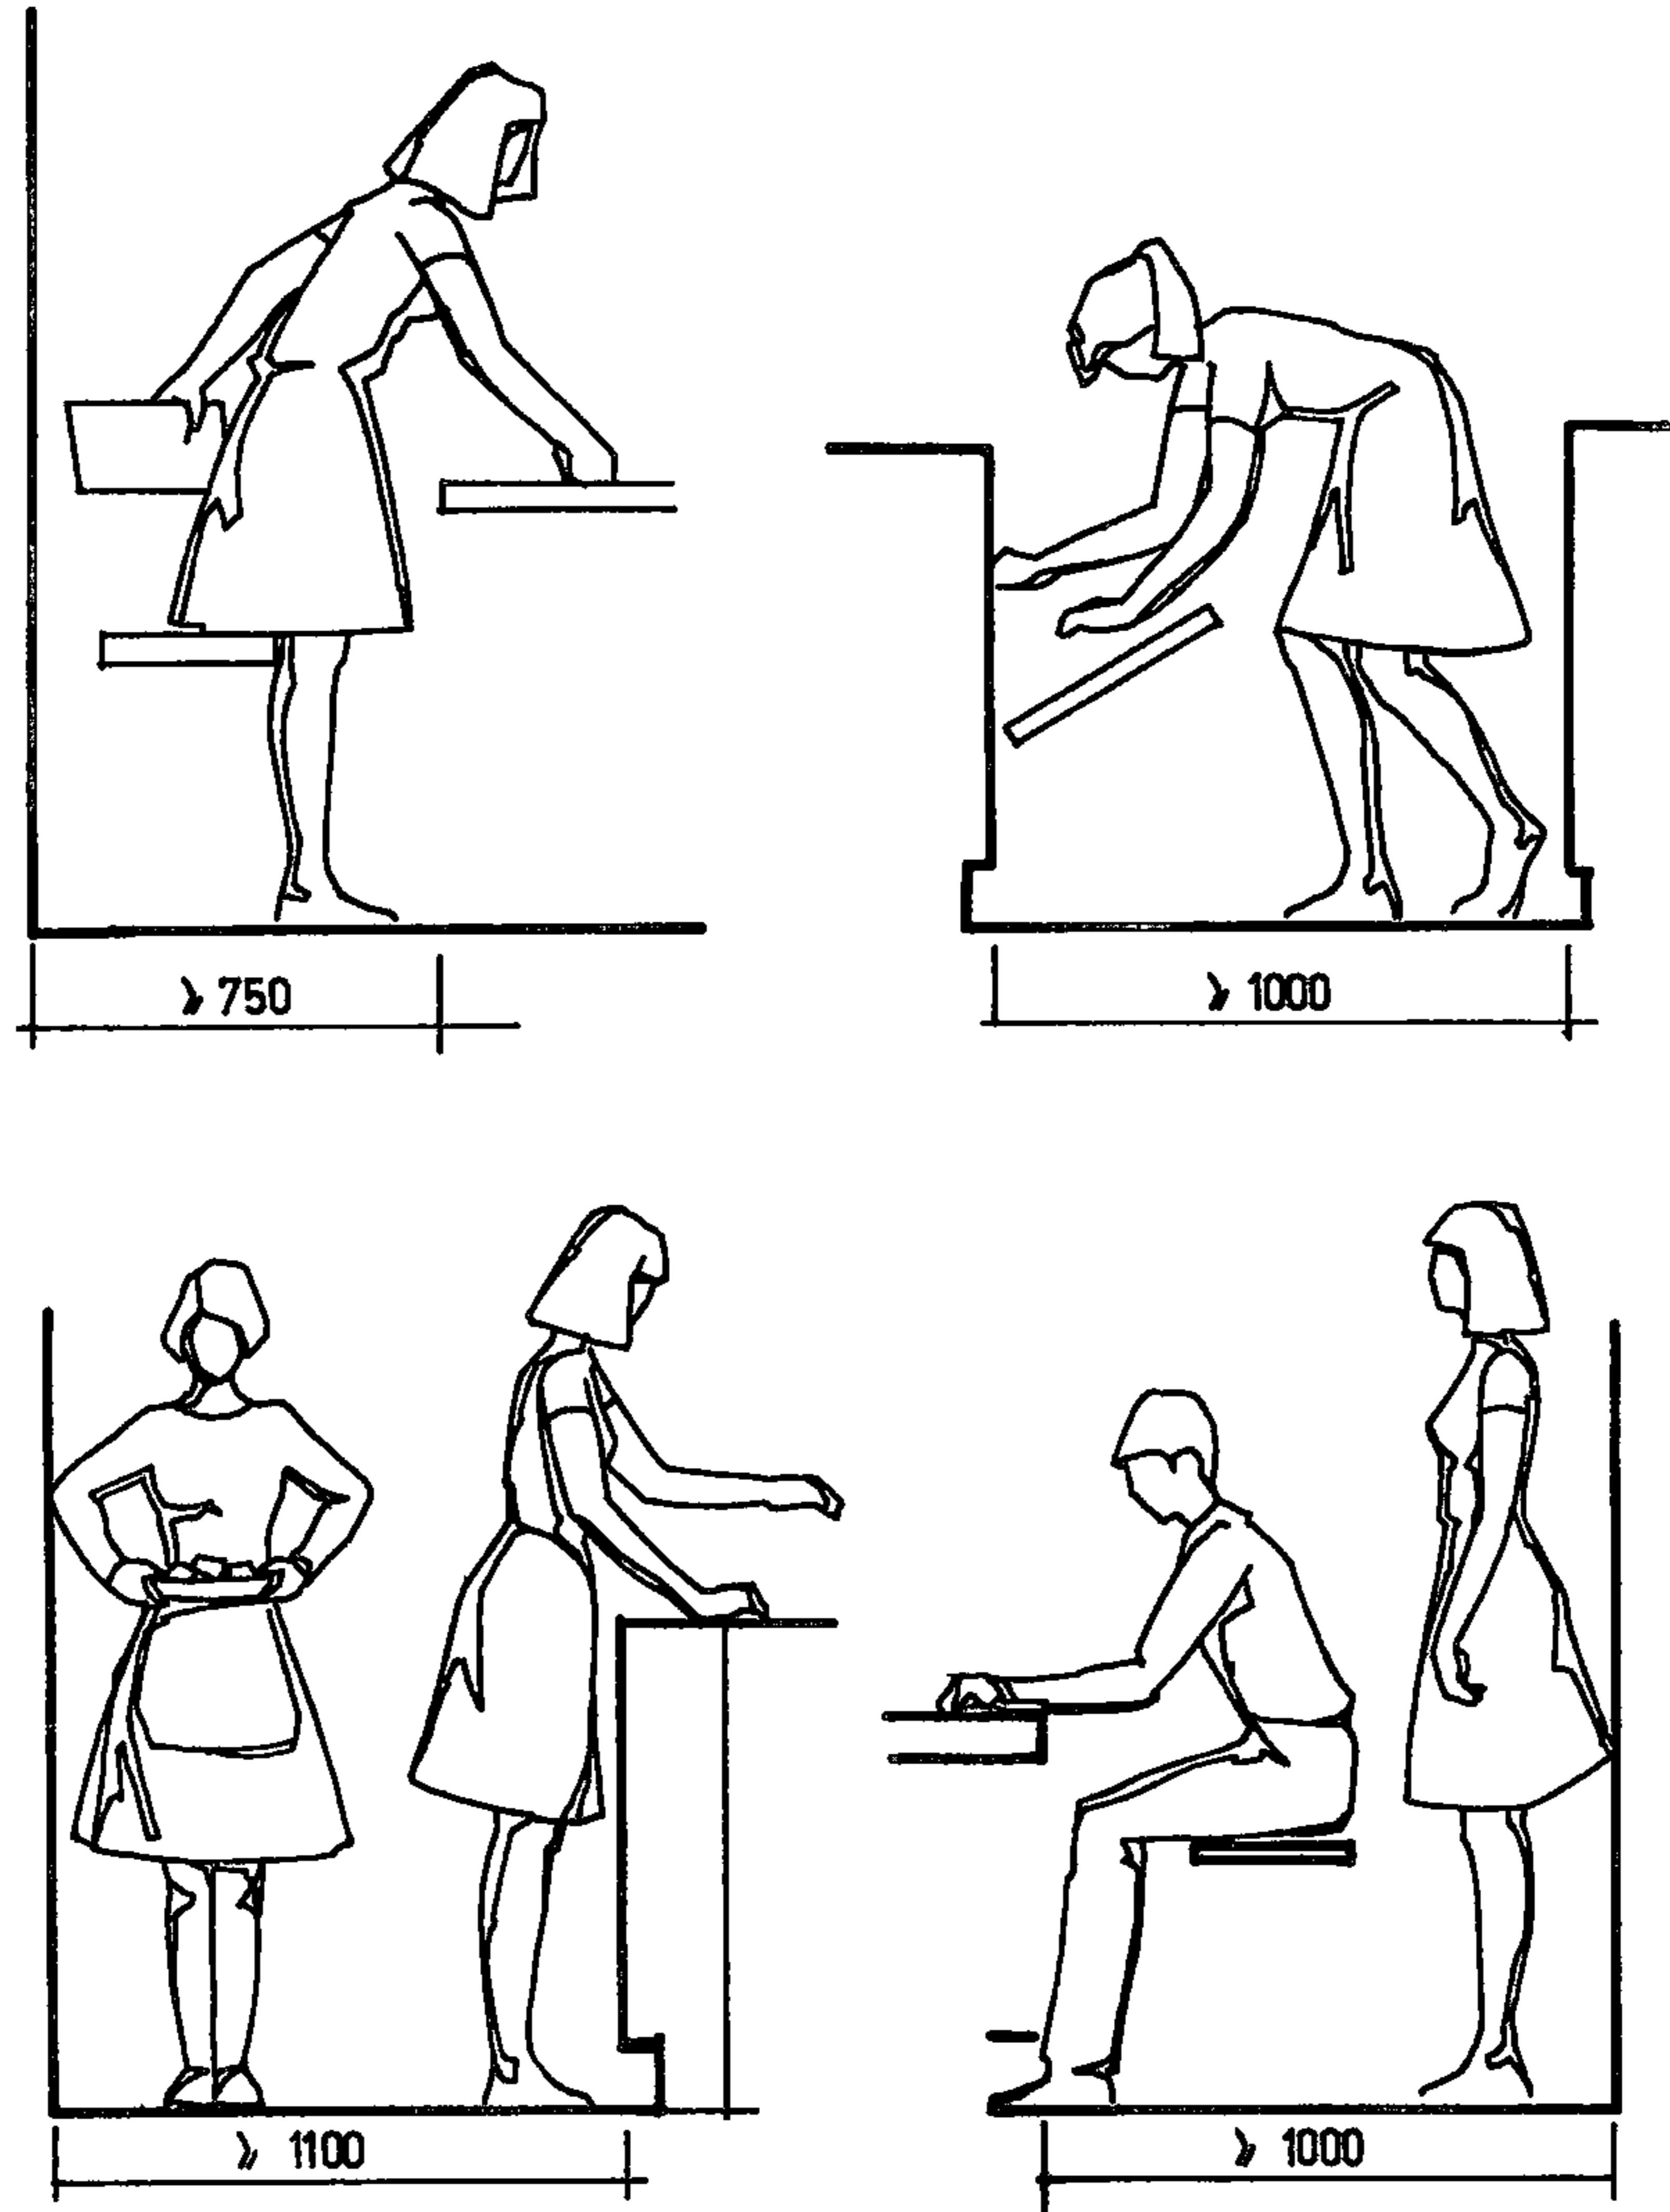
Эргономические требования к размещению кухонной мебели и оборудования в помещении
